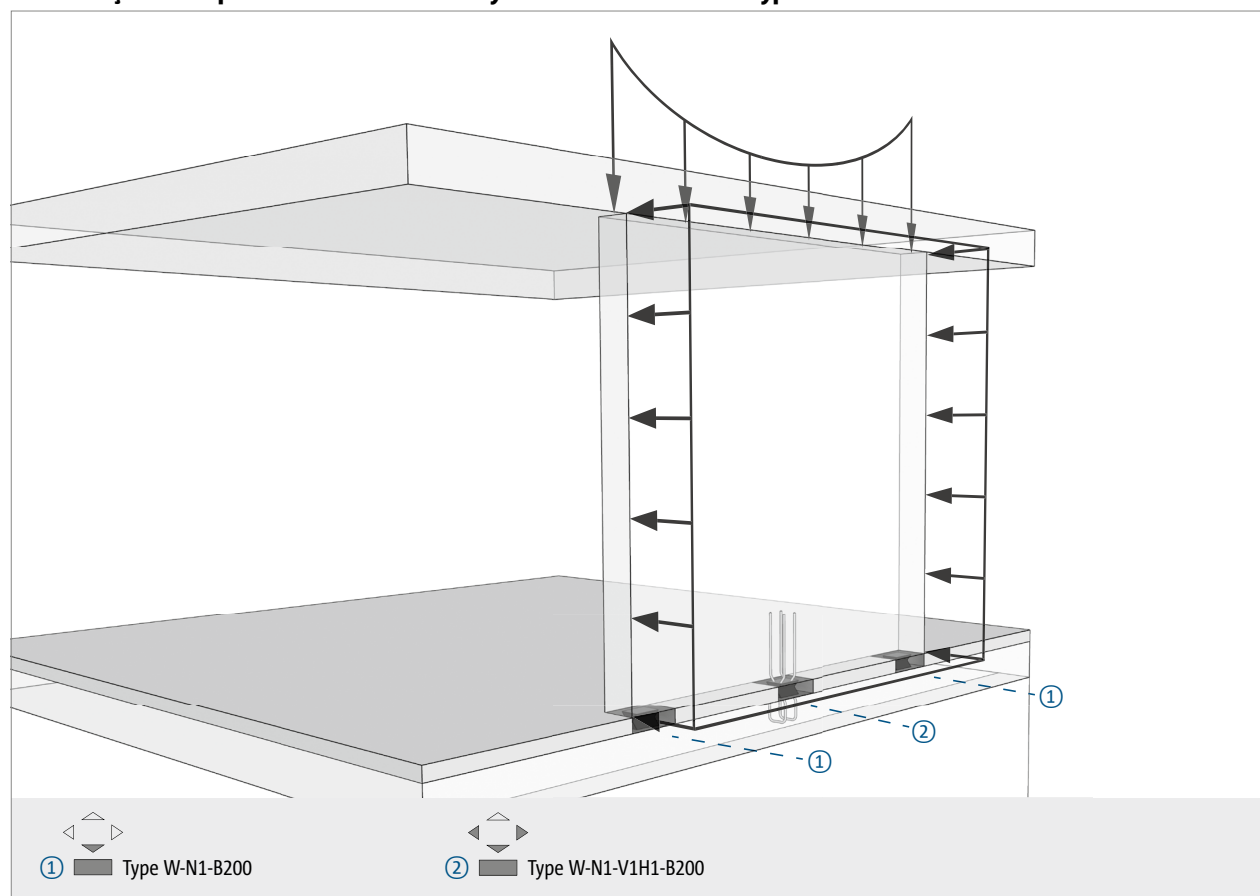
Mur de façade sous pression du vent sur la dalle, désolidarisé
